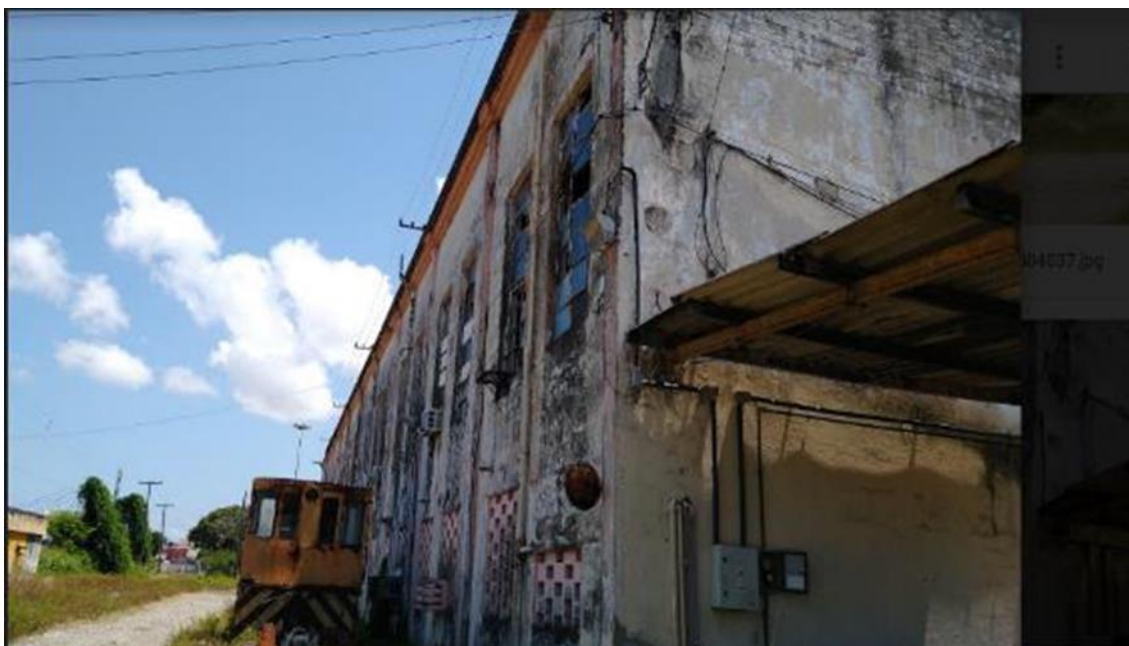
Parede externa do galpão completamente comprometida. Ferragens expostas e oxidadas, janelas desabando e revestimento caindo
